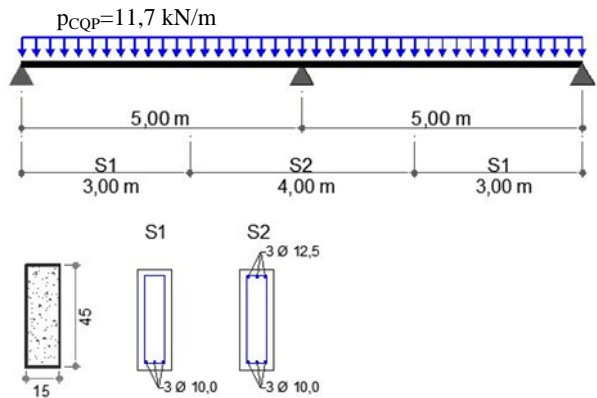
Geometria, armação e carregamento da viga VC-1
